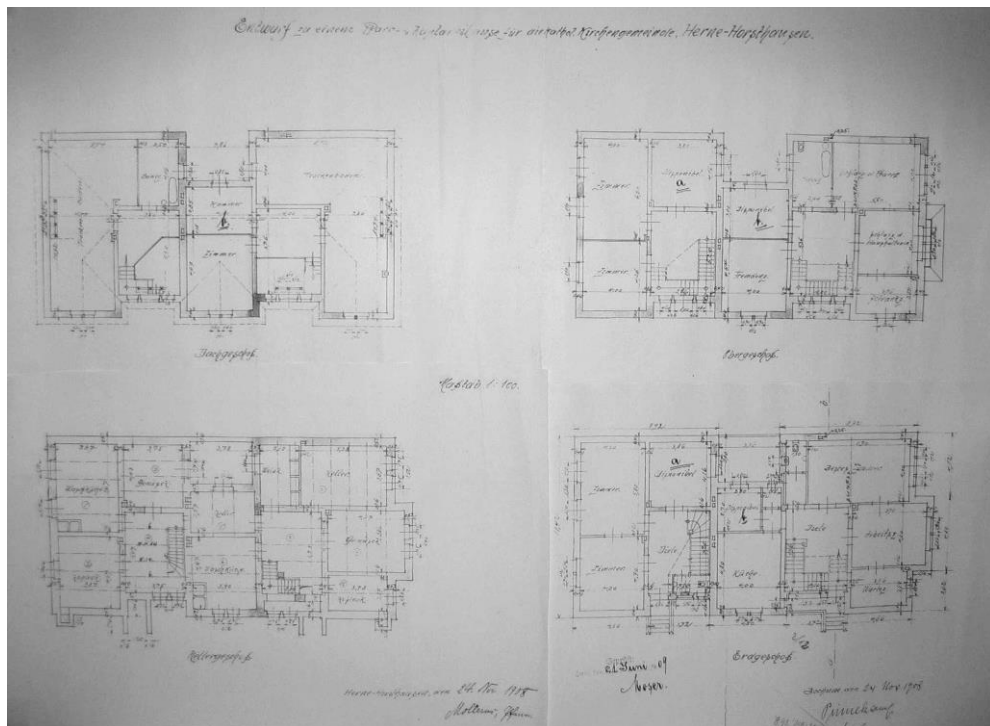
„Entwurf zu einem Pfarr- und Kaplaneihause für die katholische Kirchengemeinde, Herne-Horsthausen“, Grundriss, 24.11.1908
